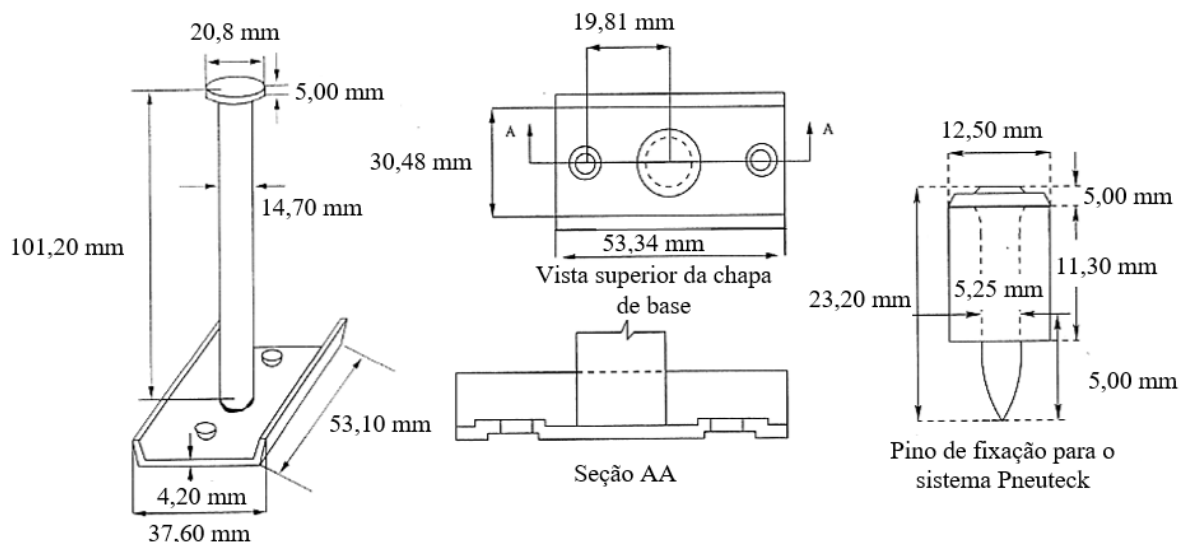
Conector não soldado (Tahir *et al.*, 2009).
